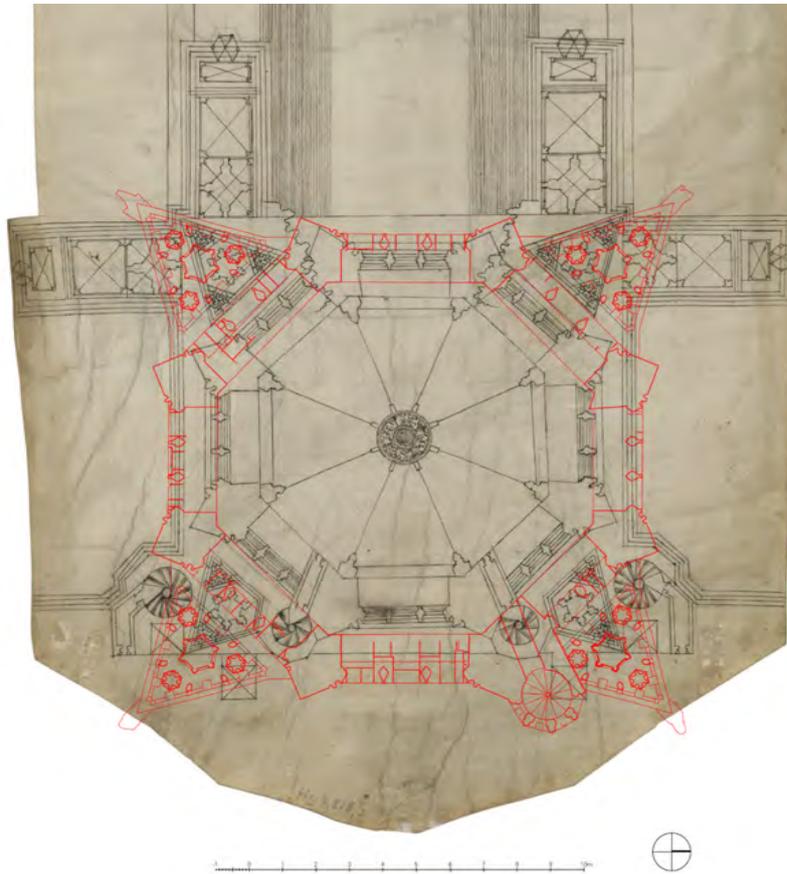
Überlagerung mit dem Grundriss der Oktogonhalle, bei mittiger Positionierung
